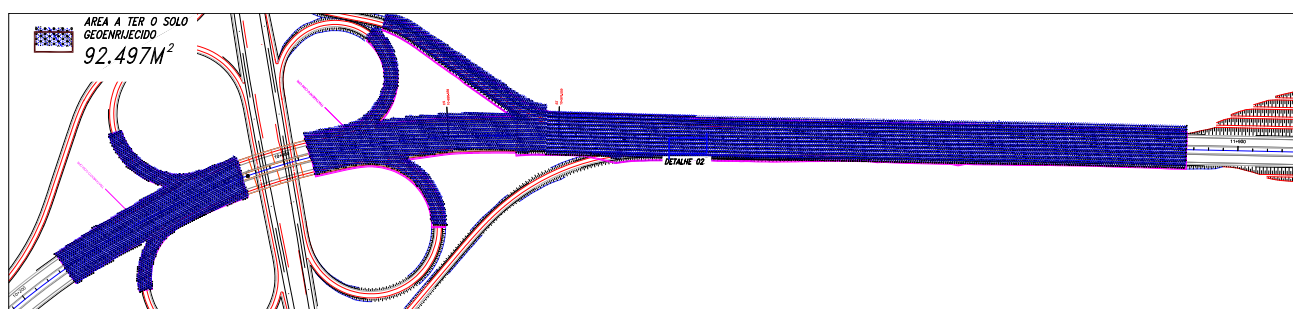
Vista em Planta do Segmento P|02 - BR-470.
